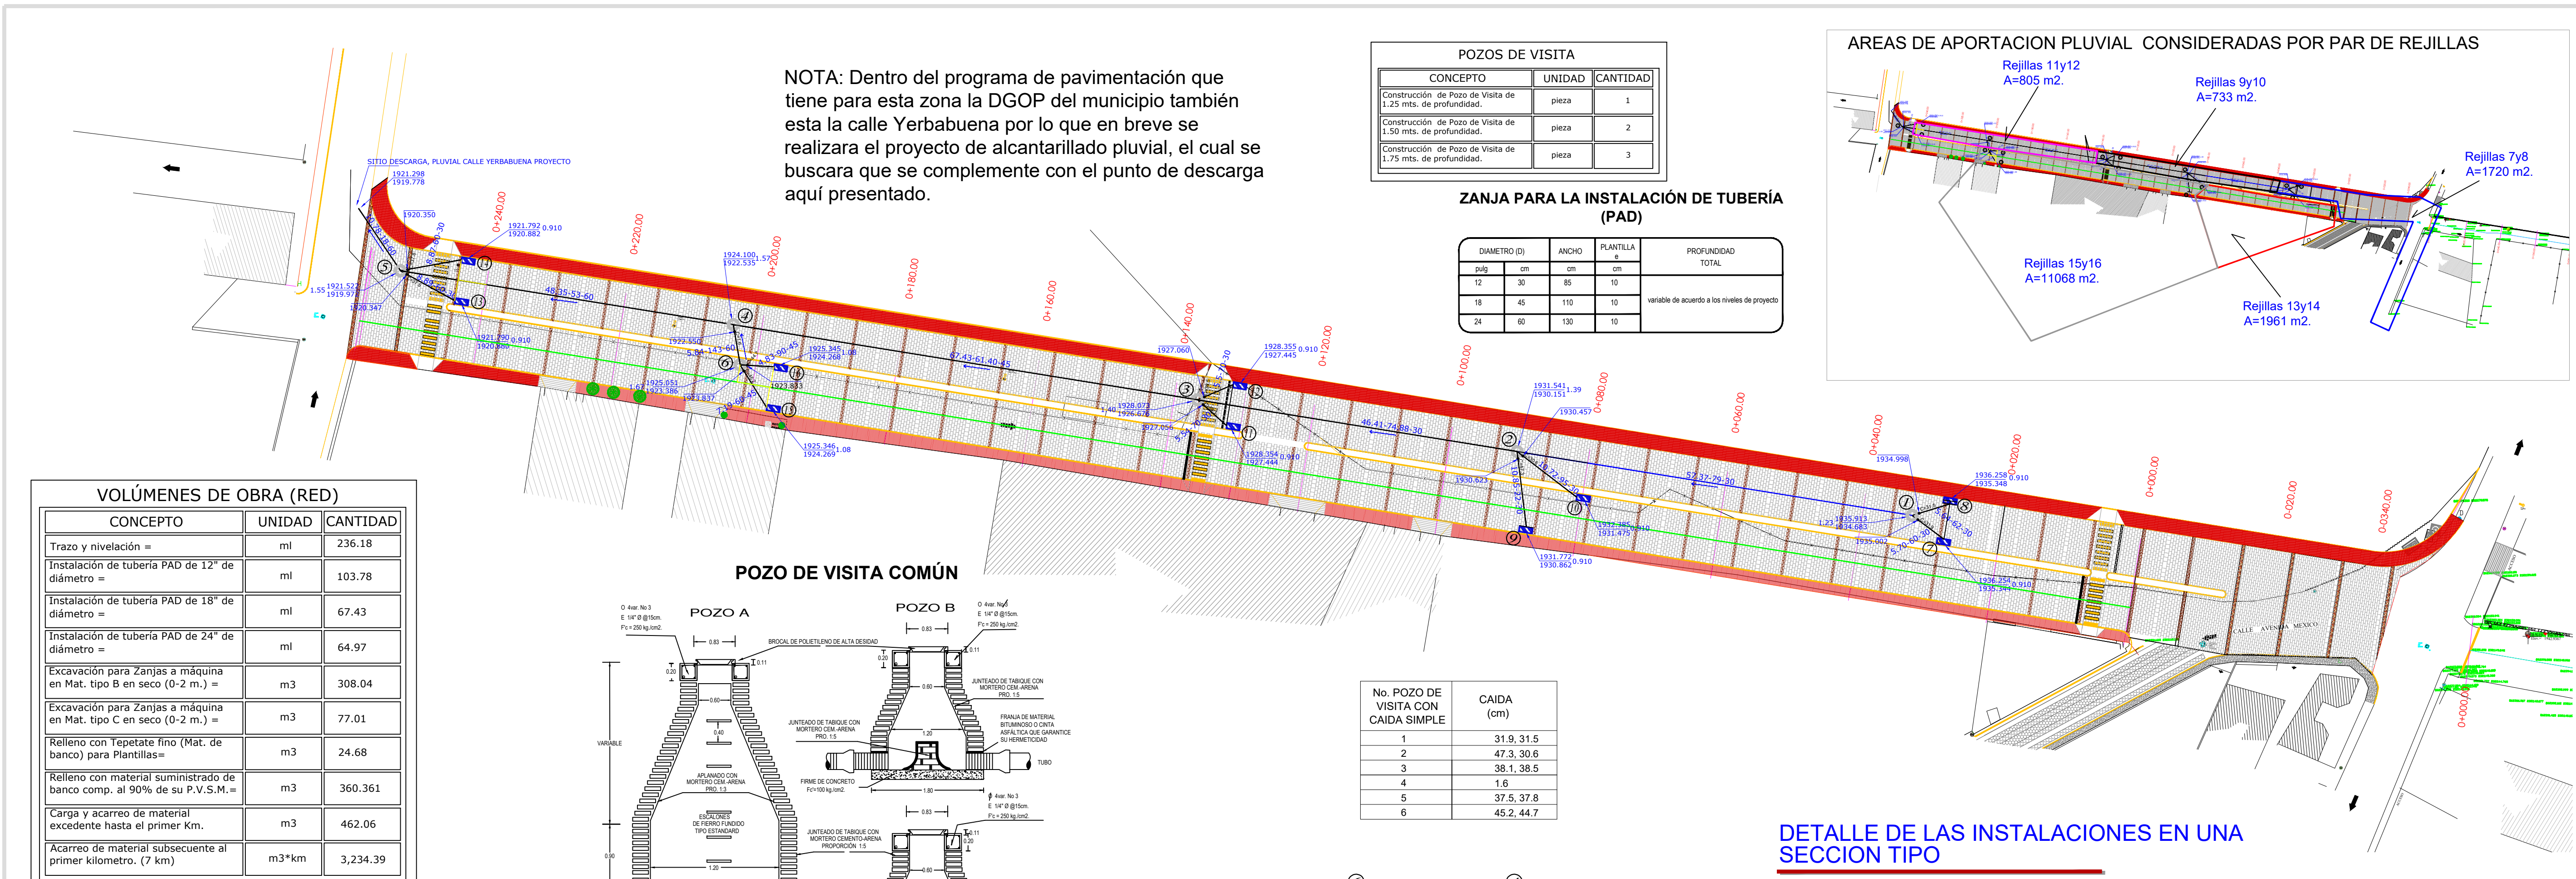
Detalle de zanja. Plano de drenaje pluvial de la calle.
